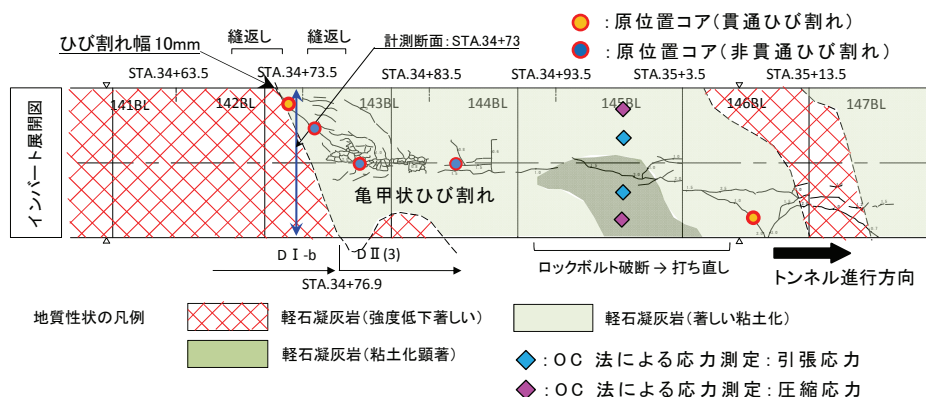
インバートのひび割れ展開図および地質平面図(SL 盤)
